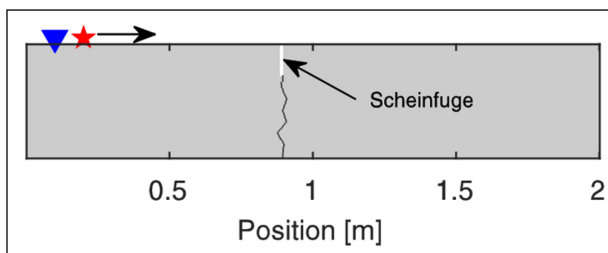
Plattenmodell mit Querscheinfuge (Kerbschnitttiefe 6 cm) und durchgehendem Vertikalriss
